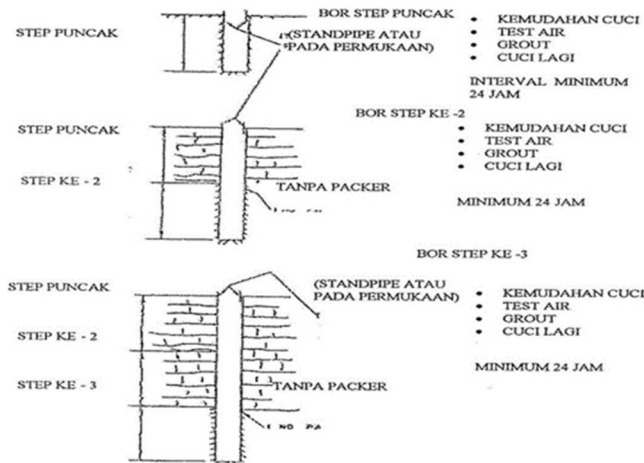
Detail pekerjaan grouting pada bangunan pelimpah (tampak potongan memanjang)
